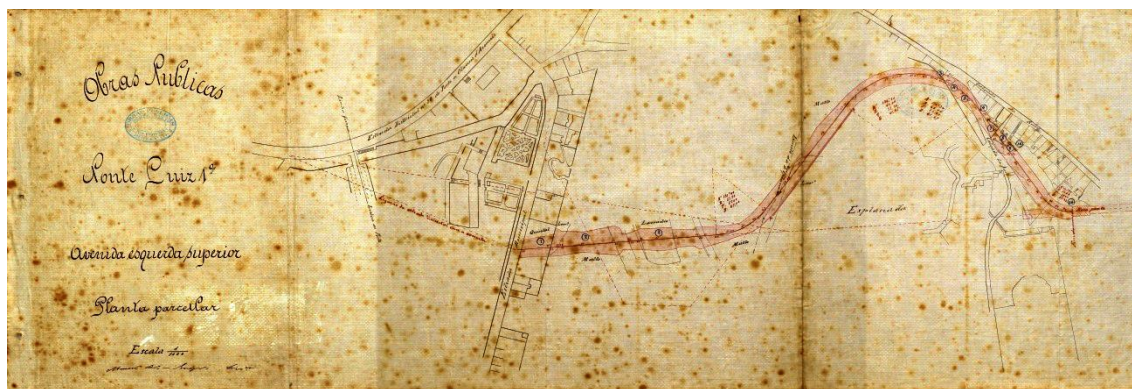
| Planta parcelar do Projeto da Avenida Esquerda Superior da Ponte Luís I
